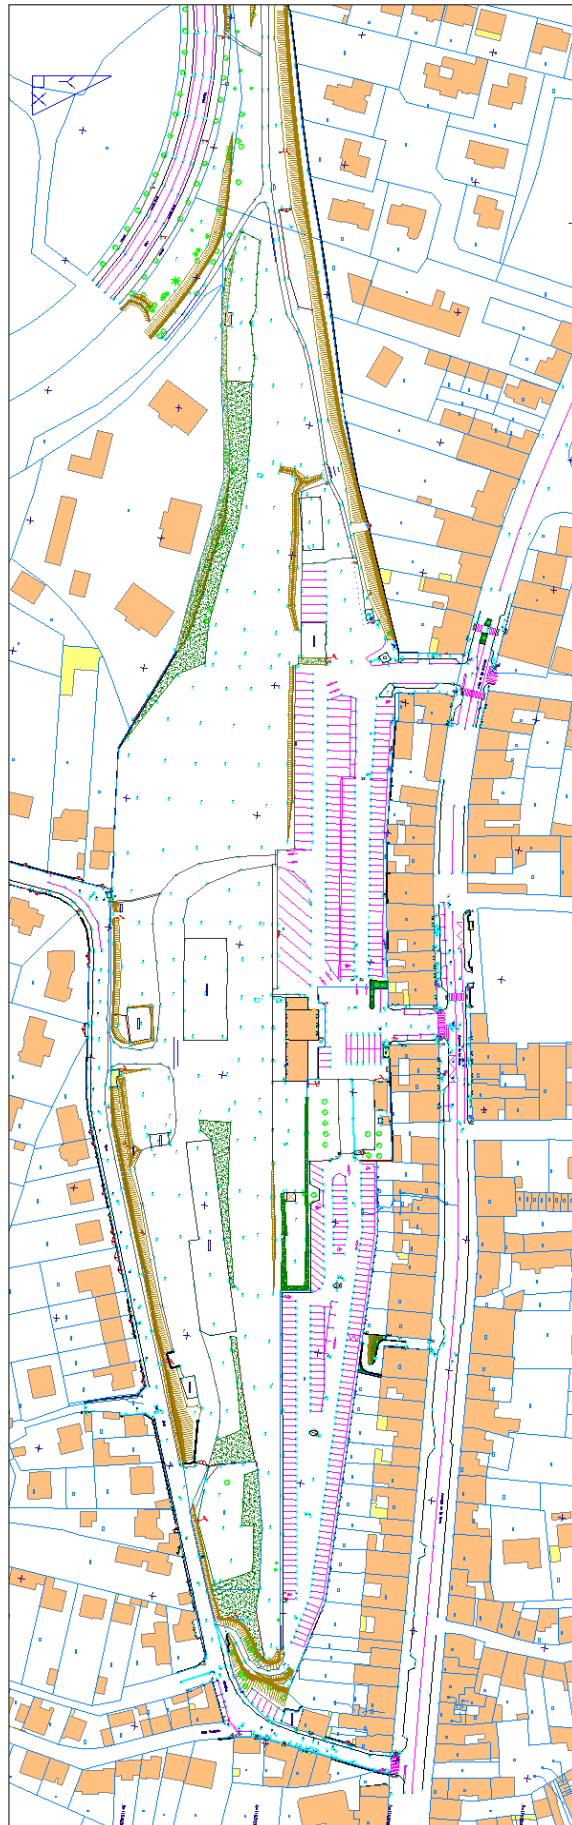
Plan topographique de la zone d'étude (CIT janvier 2019)
